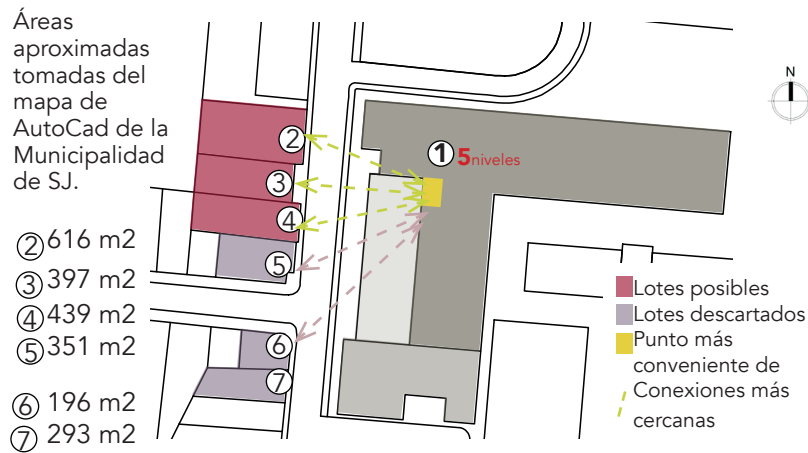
Áreas Lotes (2018) Fuente: Zheng Yang, K.
